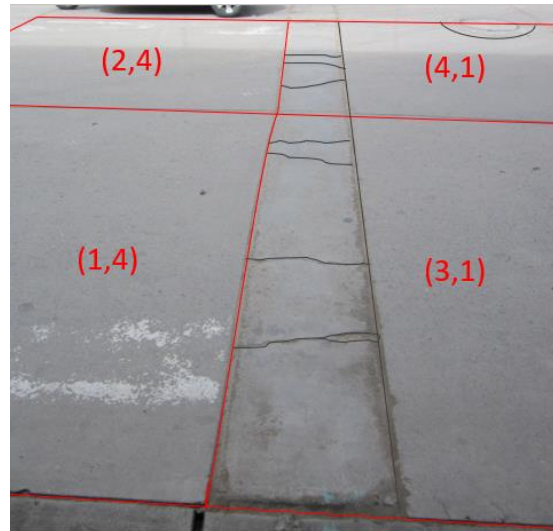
Grietas en bloque de losa (3,1) de la unidad de muestra T2 – U08. Fecha: 10/03/2017.
